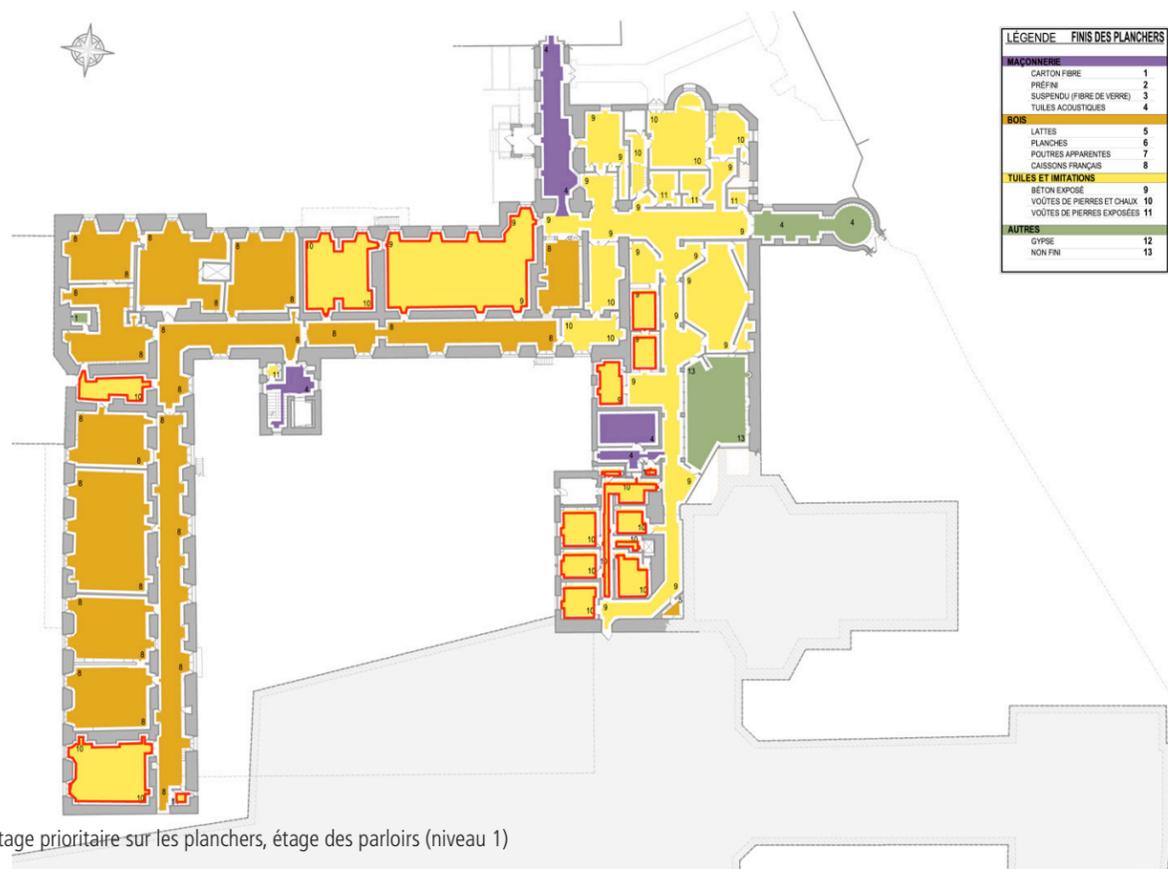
Plan de curetage prioritaire sur les planchers, étage des parloirs (niveau 1)
